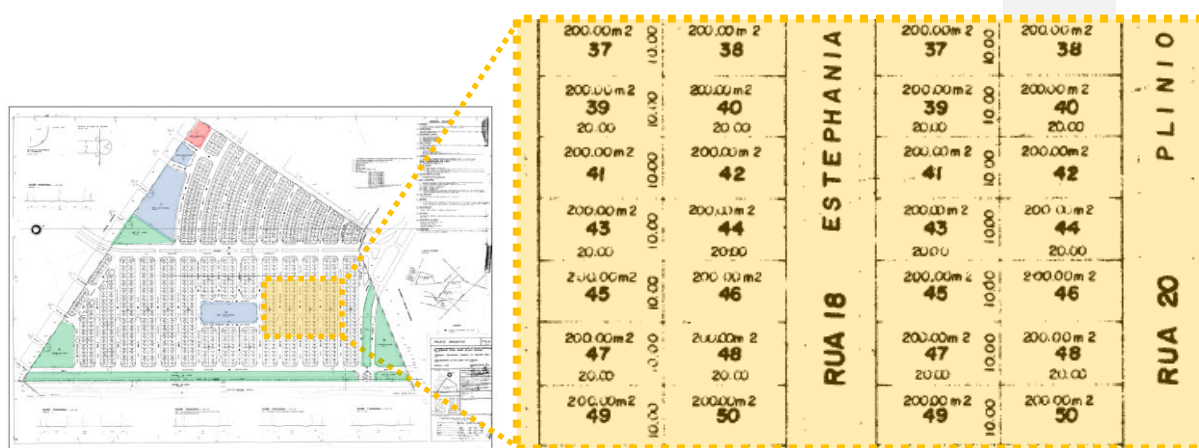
Implantação e detalhe do Conjunto Habitacional Antônio Marincek implantado pela COHAB-RP - subsetor Norte 7 na década de 1970.
